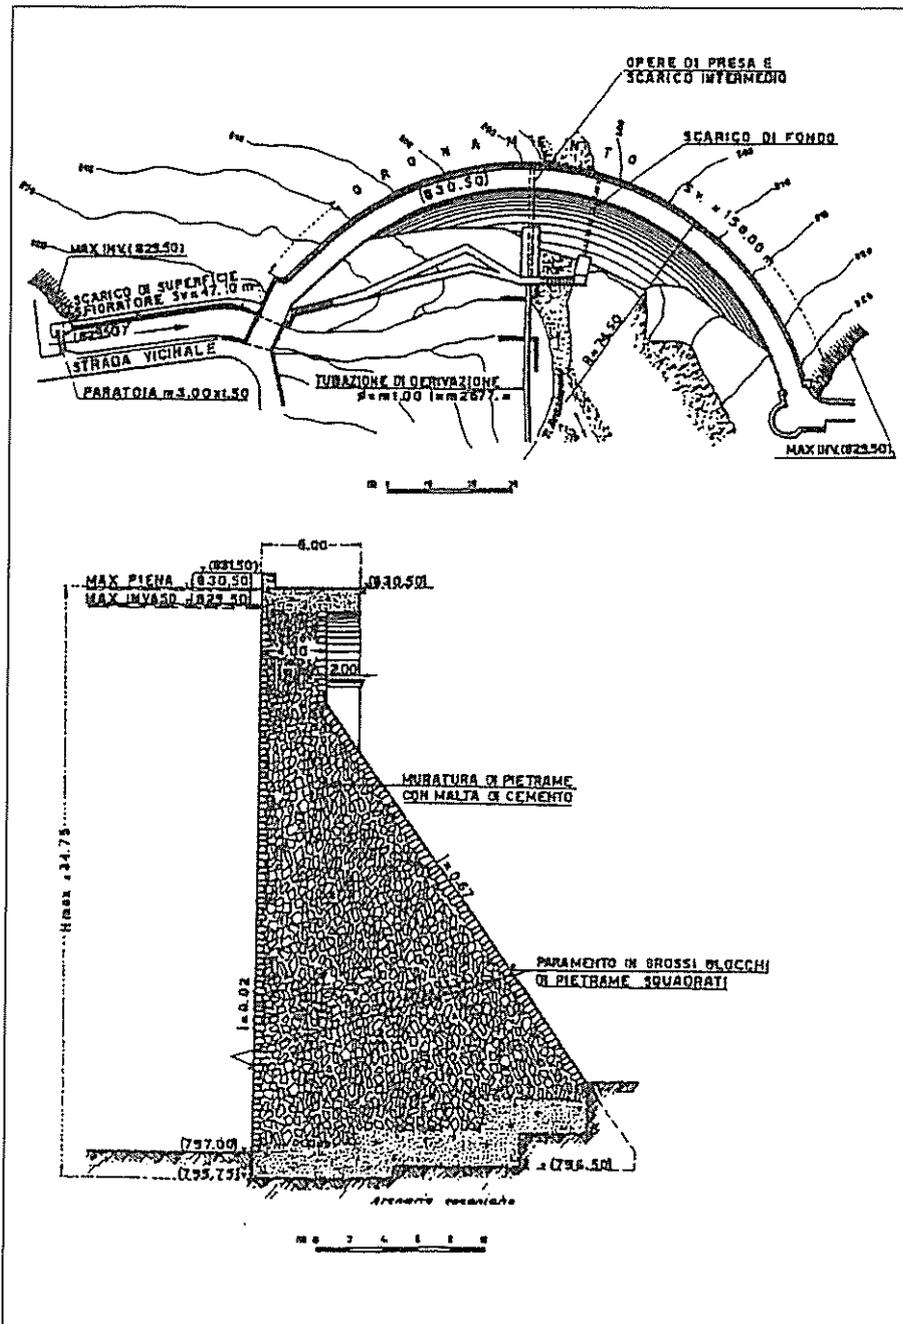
Diga Scalere: Planimetria - Sezione tipo.
